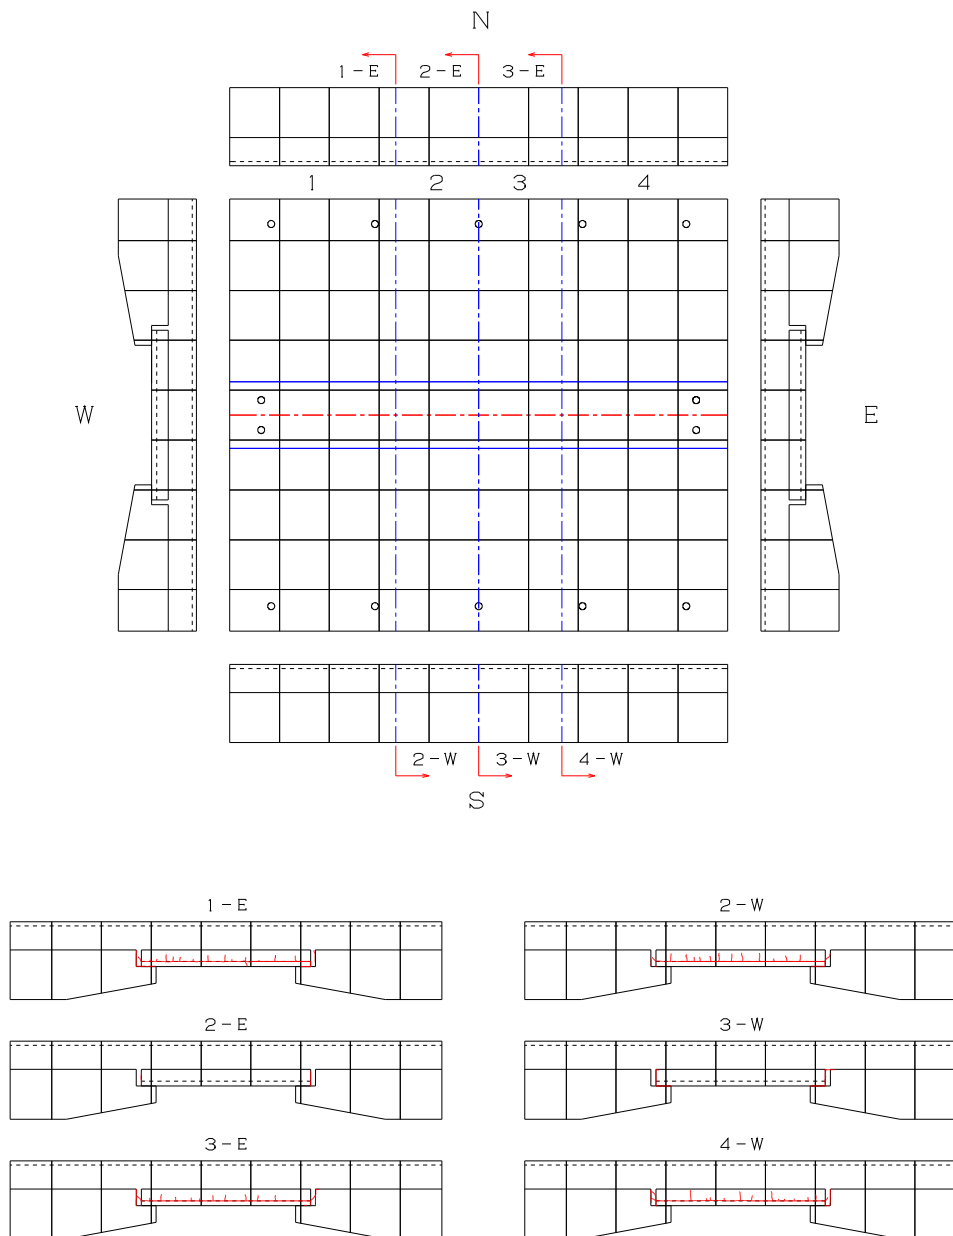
供試体切断位置と切断面のひび割れ図
